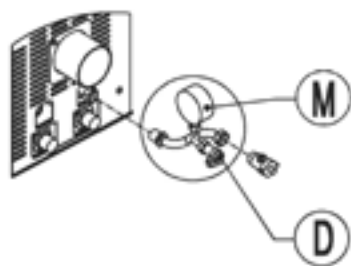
Terminale con rubinetto di caricamento (D) e manometro (M)
